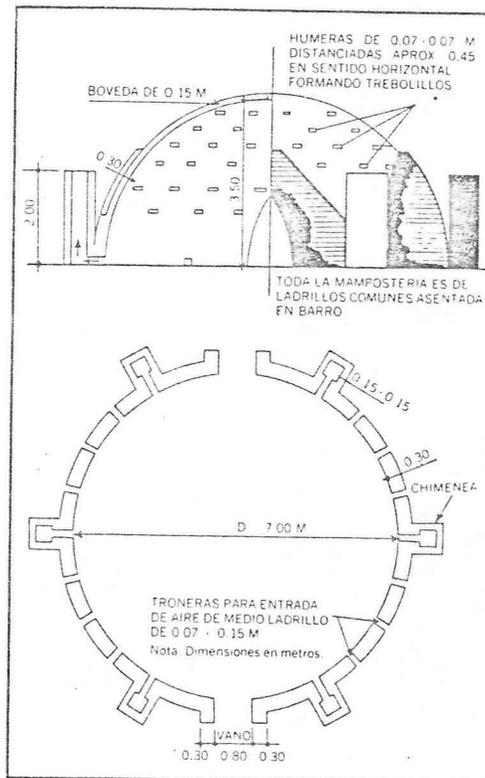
Parva de mampostería con chimeneas y humeras
